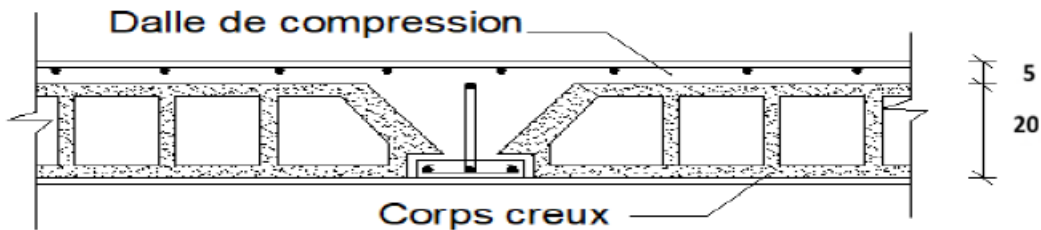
Schéma du plancher corps creux (20+5) cm
